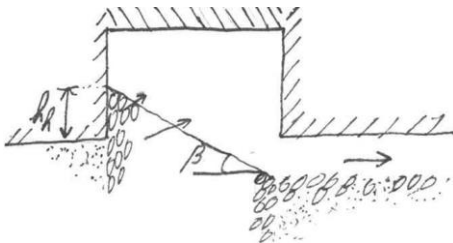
Uitspoeling van bovendeel barrière aansluitend op benedenstroomse pipe tot ongeveer een hellingshoek gelijk aan de hoek van inwendige wrijving. De geschetste situatie betreft een relatief brede barrière met een relatief lage inkassing (zijaanzicht met enige 3D-suggestie in langsrichting).
